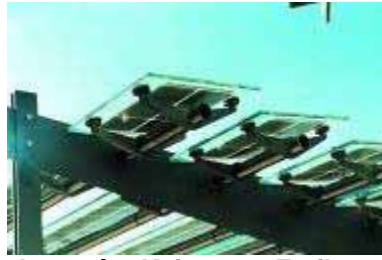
Torre Tecnológica Werta em Ohrberga na Hameln-Emmerthal, na Alemanha
